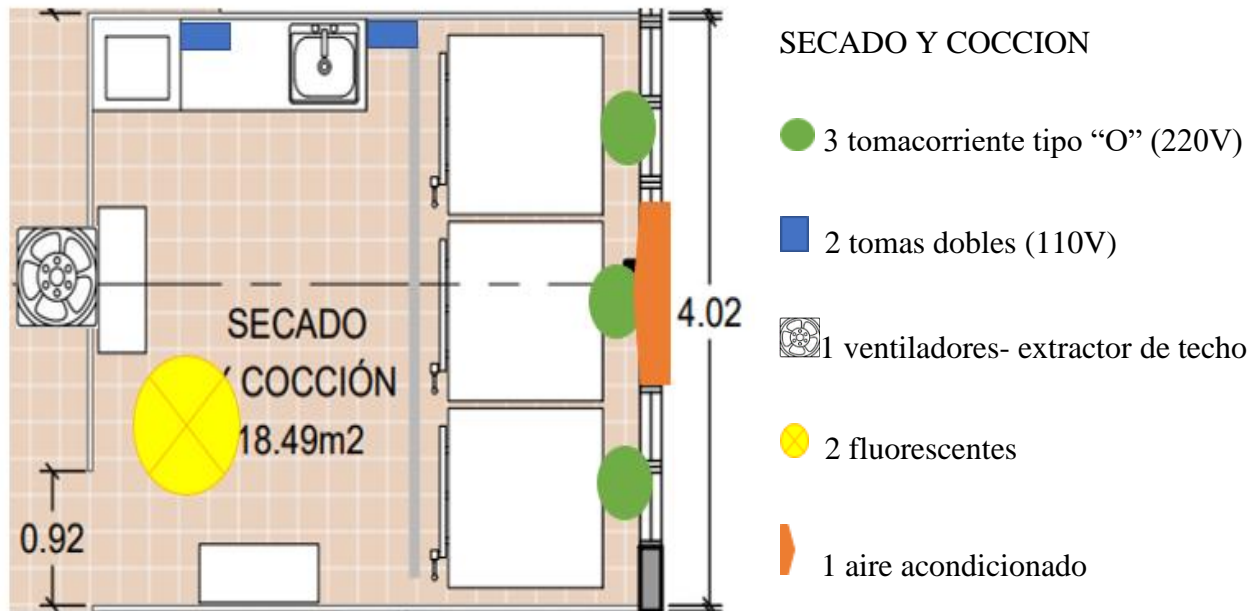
Plano eléctrico - secado y cocción, fuente: autores
